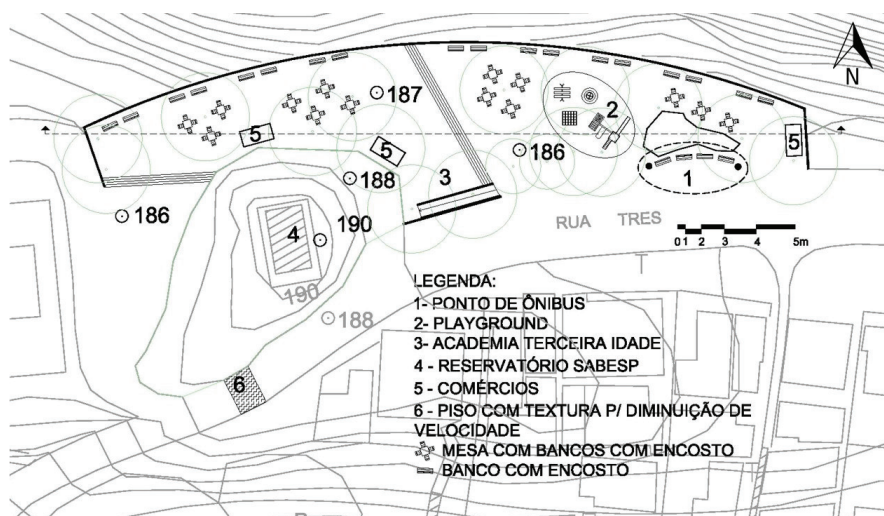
Planta do projeto de intervenção da Praça do Céu
